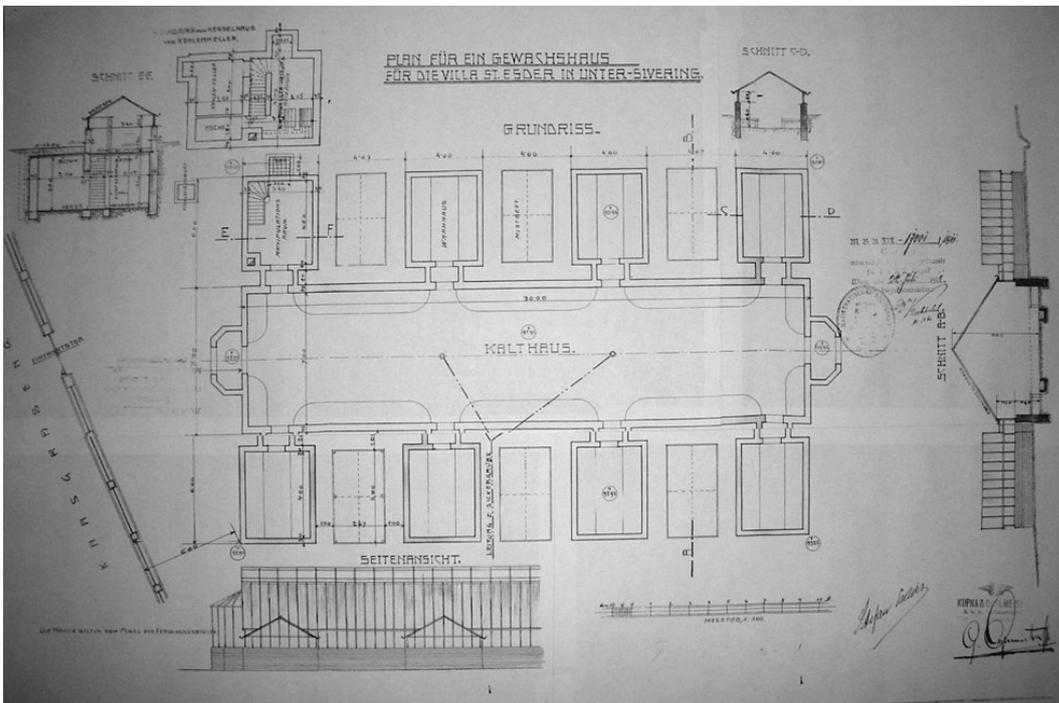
Villa Esders. Plan für ein Gewächshaus. 1911. Einreichplan.
